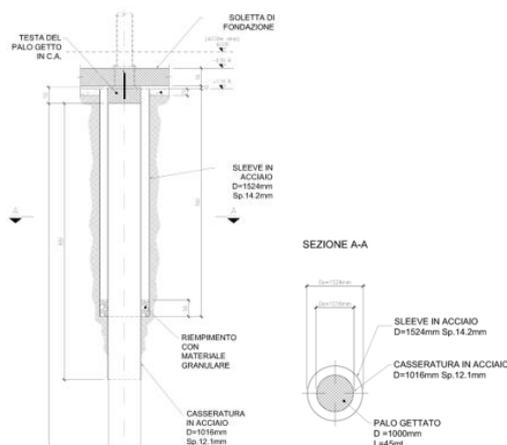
Carpenteria palo di fondazione lato terra con sleeve.
